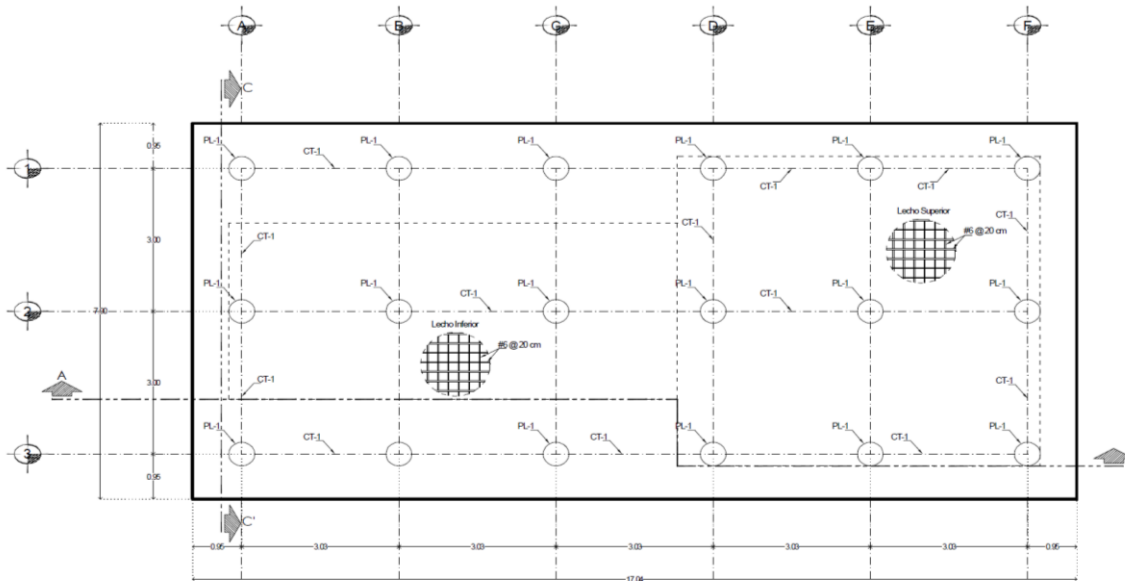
Arreglo de cimentación del turbogenerador (Vista en planta)
